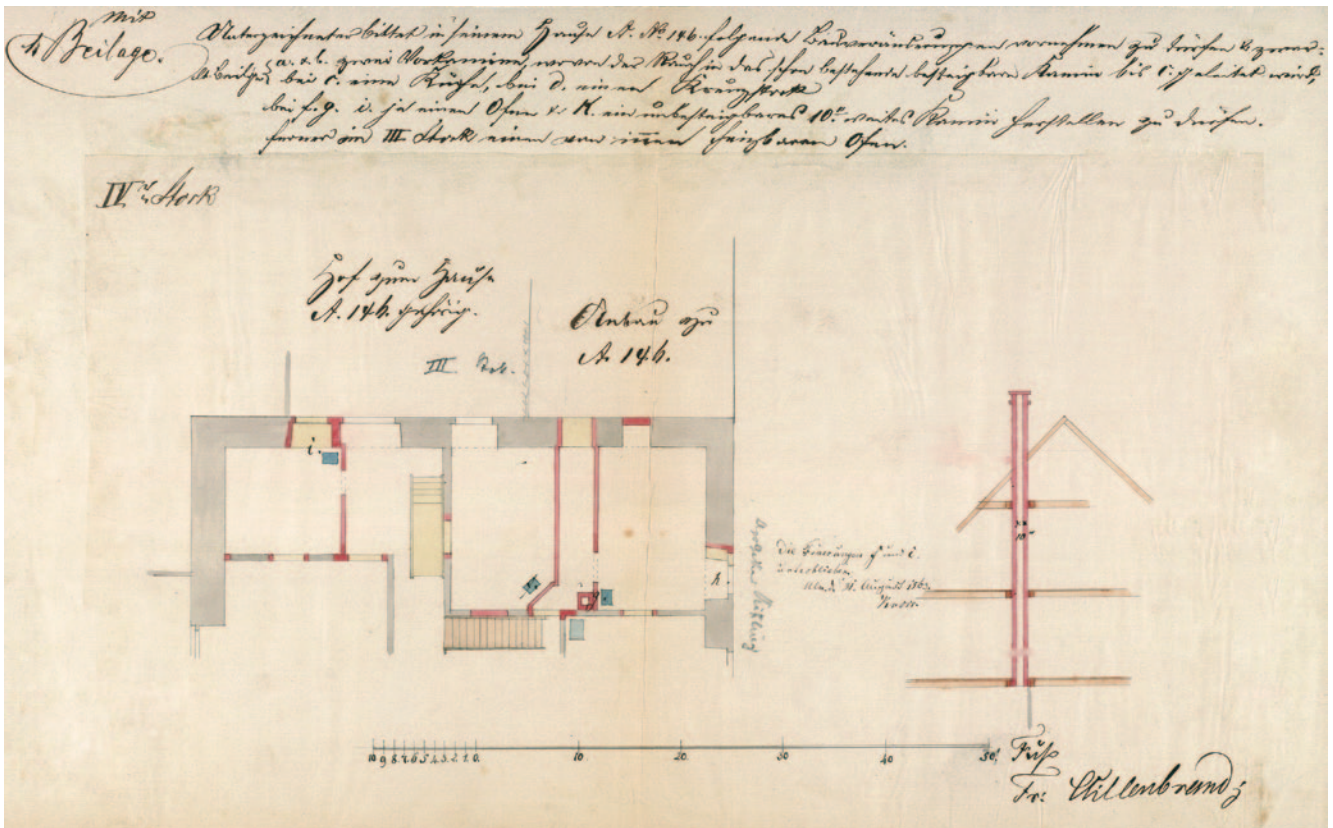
Gebäude Sattlergasse 9 (A 146), Teilgrundriss des 4. Stocks, Baugesuch 1862. Beleg für Steinbauweise bis unter Dach.
